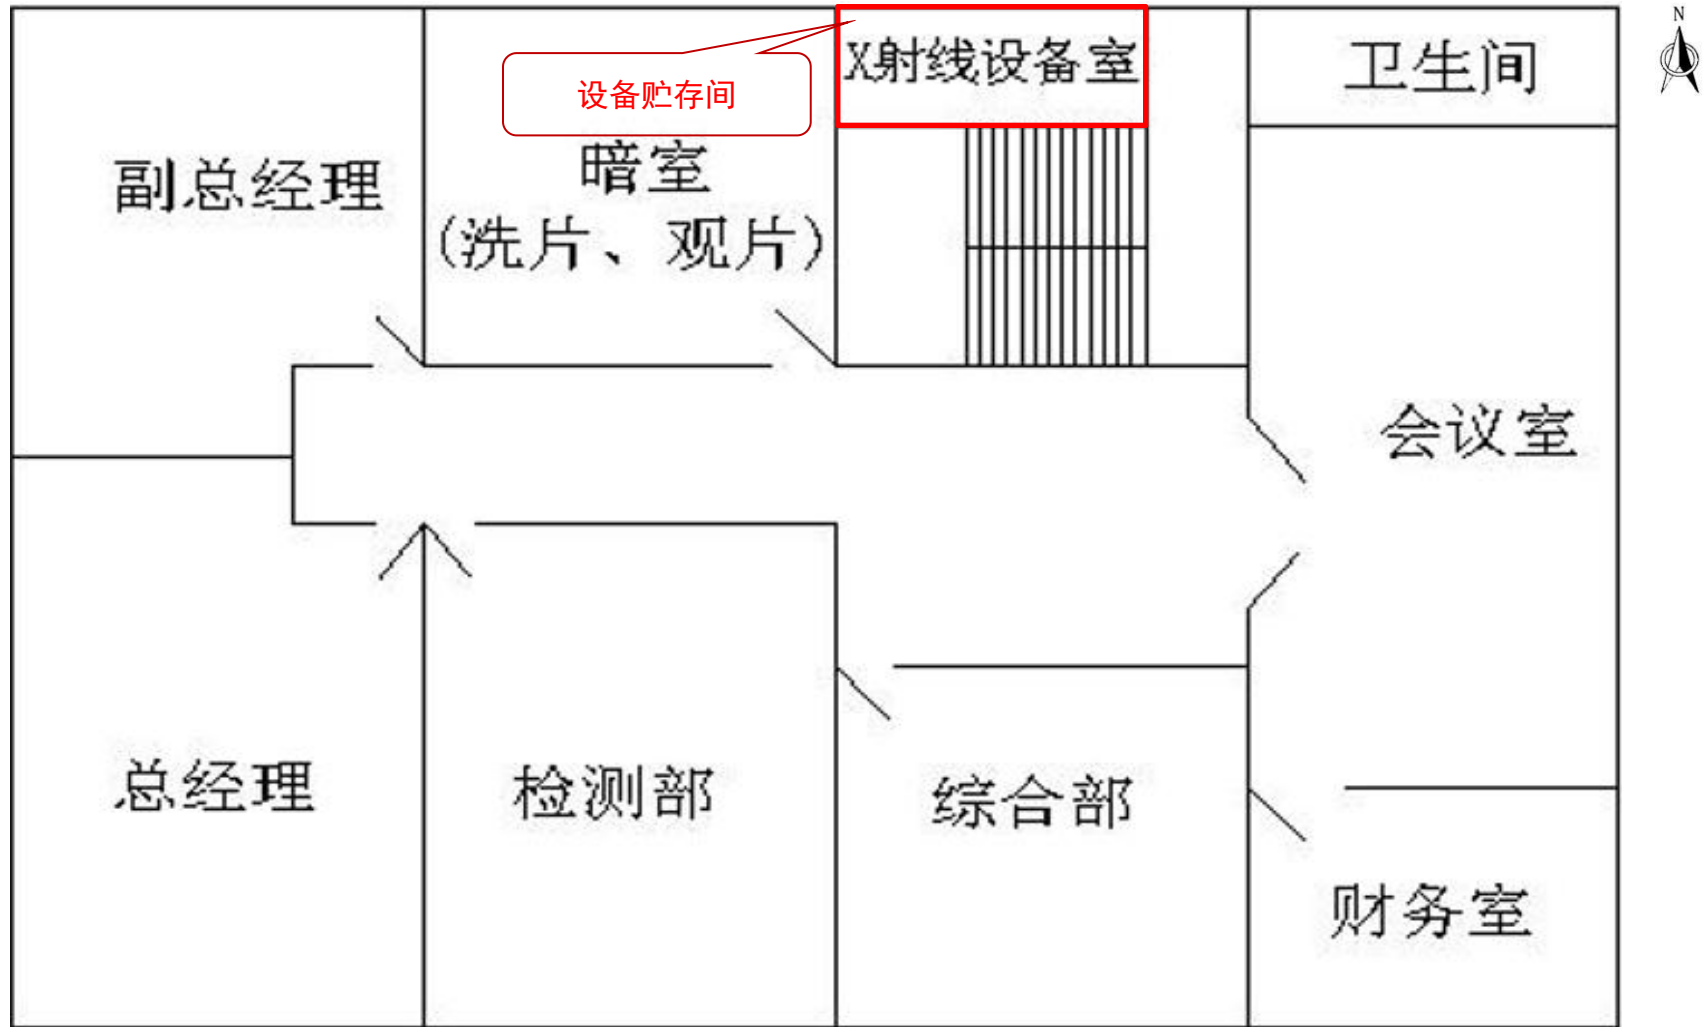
(2) 公司办公用房平面布置示意图 (二层)
